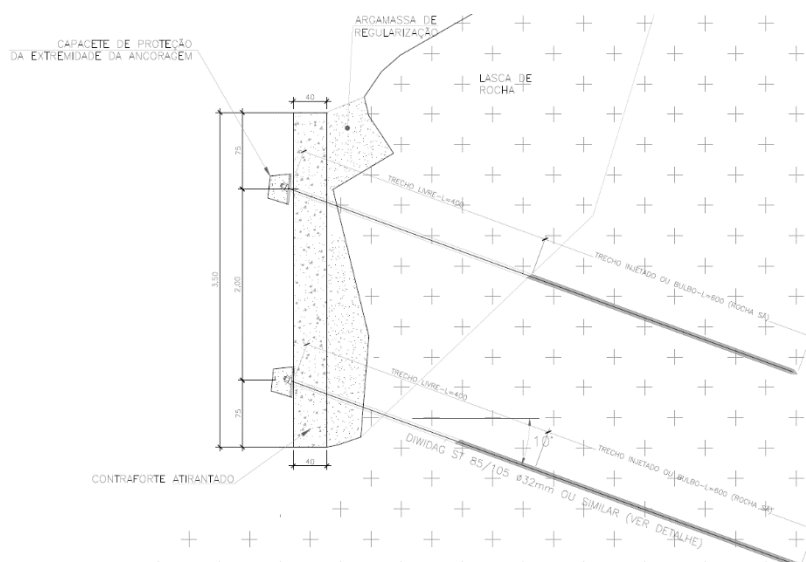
Detalhamento dos contrafortes atirantados (vista lateral)
